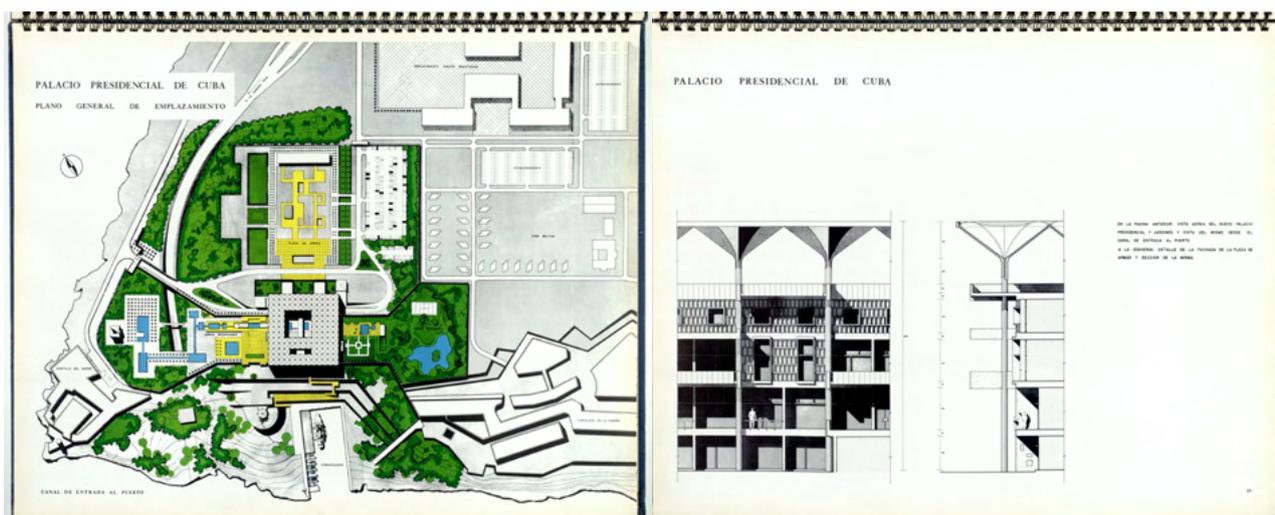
e Fig. 8 Tavole di piano estratte da *Plan Piloto de La Habana, Directivas Generales. Diseños preliminares - soluciones tipo*. TPA, 1959. La fig. 7 riporta l'impianto planimetrico del nuovo complesso governativo, mentre la fig. 8 contiene un dettaglio del prospetto e della sezione della facciata dell'edificio principale
